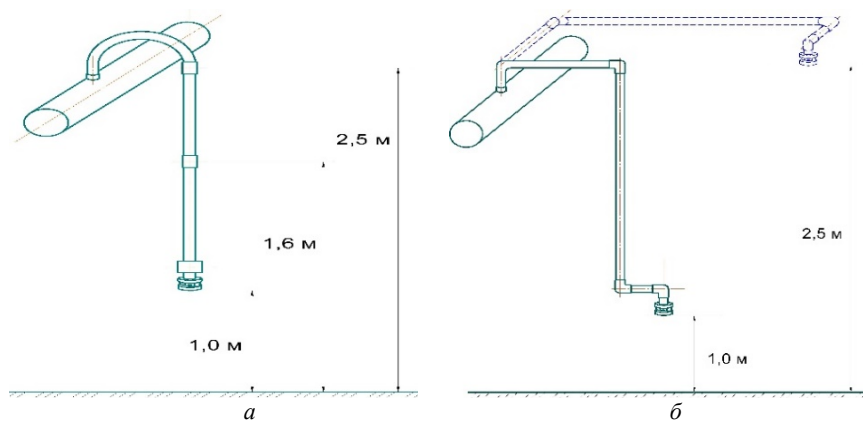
Схемы устройств приповерхностного дождевания:
